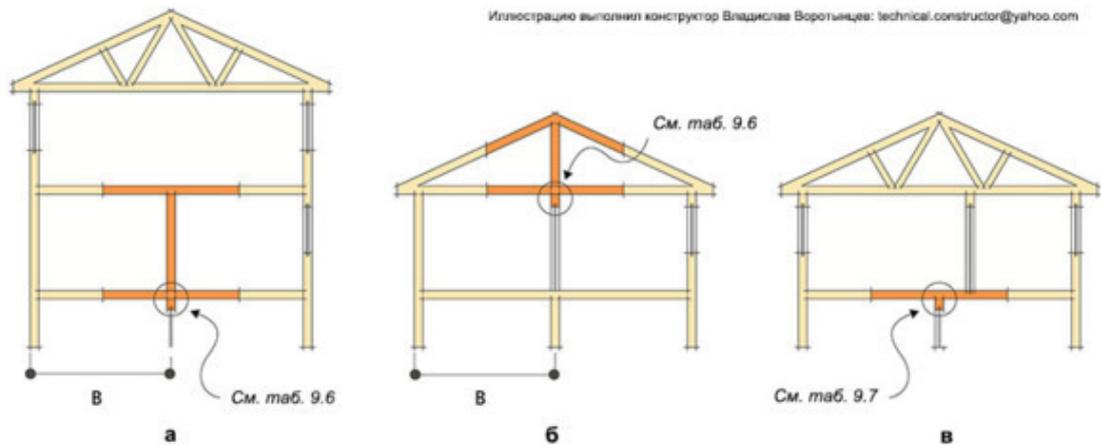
Выбор сечения перемычек в несущих внутренних стенах в зависимости от характера загруженности: а – внутренние стены, несущие нагрузку от двух междуэтажных перекрытий; б – внутренние стены, несущие нагрузку от кровли; в – внутренние стены, несущие нагрузку от одного междуэтажного перекрытия
